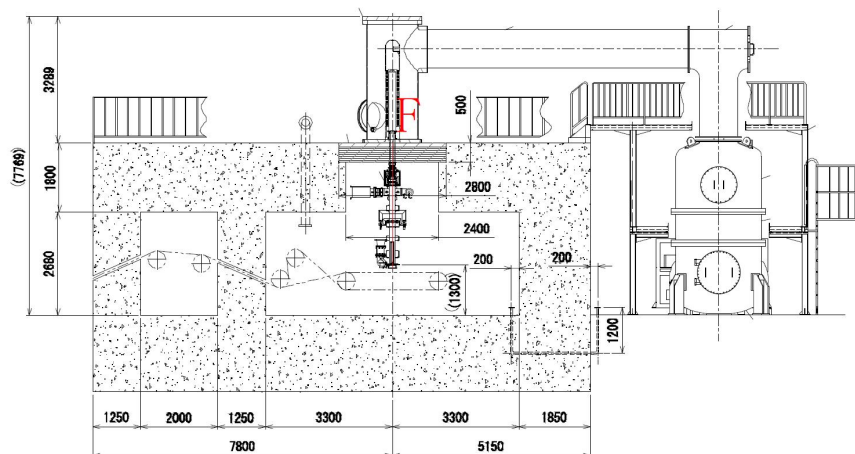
辐照室屏蔽结构立面图（尺寸单位：mm）
